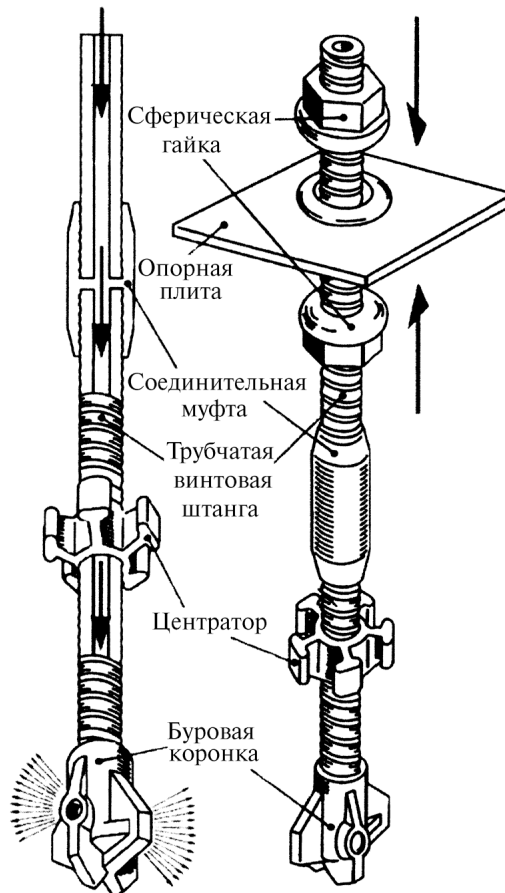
Конструкция анкера (микросваи) из трубчатой винтовой штанги
